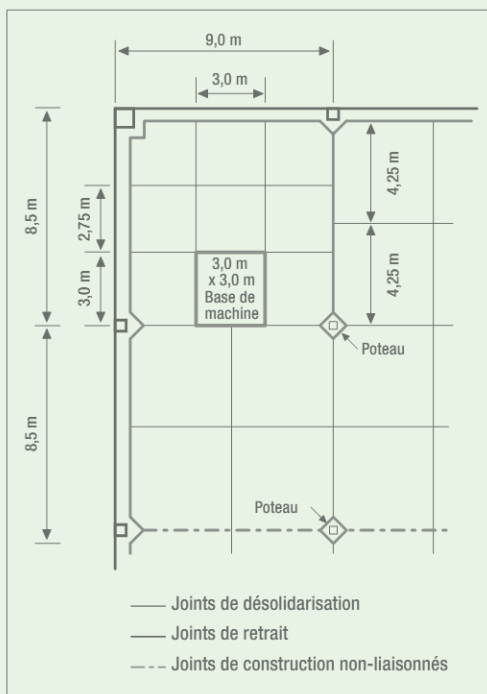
Disposition caractéristique des joints dans une dalle³
